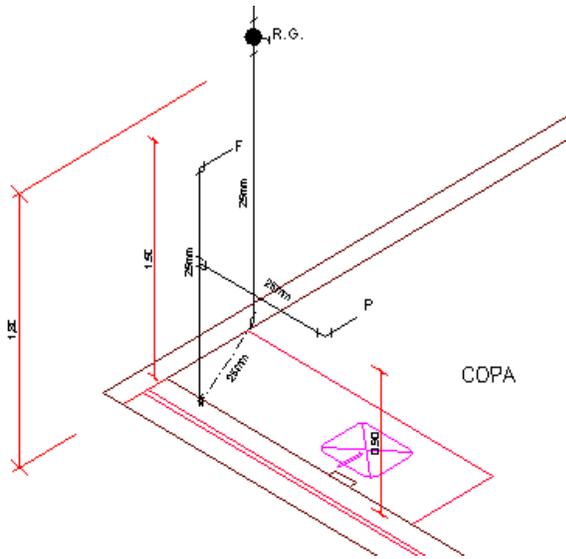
Exemplo de Planta Baixa Isométrica escala 1:20 ou 1:25.
